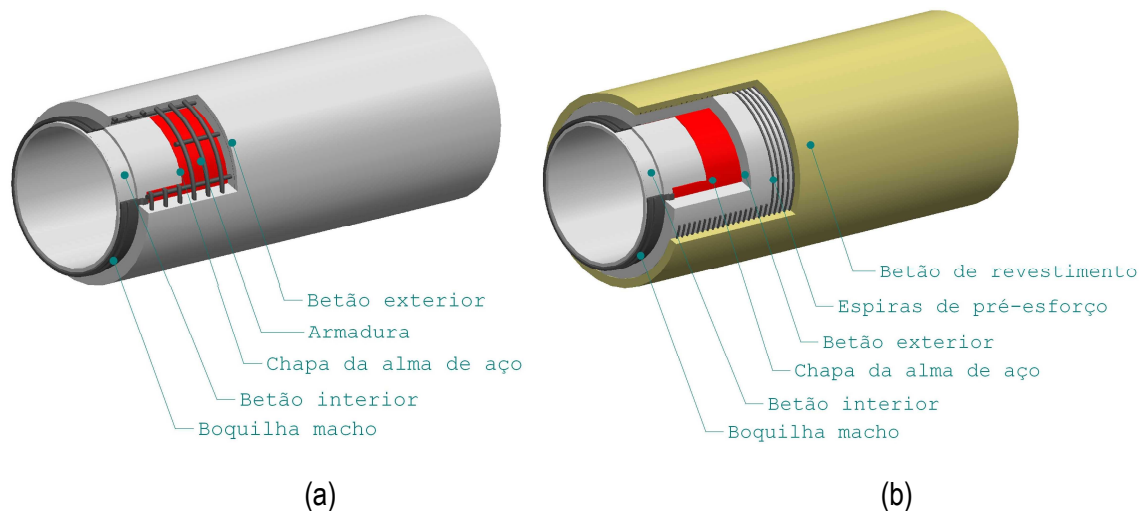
Tubagem de Betão (a) Armado com Alma de Aço e (b) Pré-esforçado com Alma de Aço
